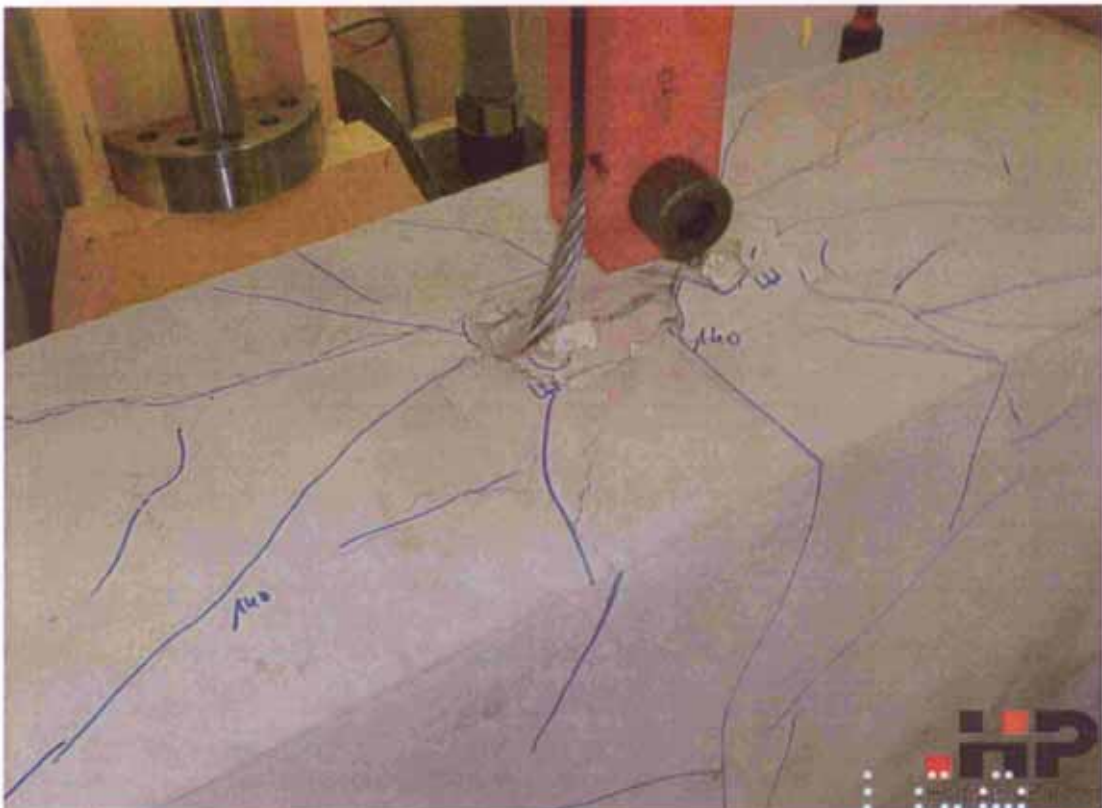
Versuchsende bei starker Rissbildung und beginnendem Betonausbruch
